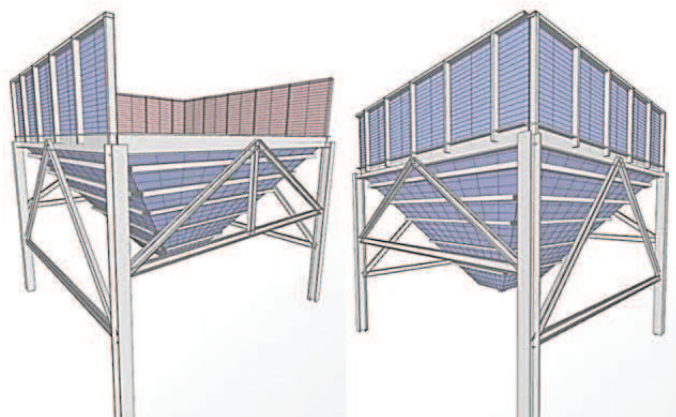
H Detall estructural de la tremuja (SAP2000)
